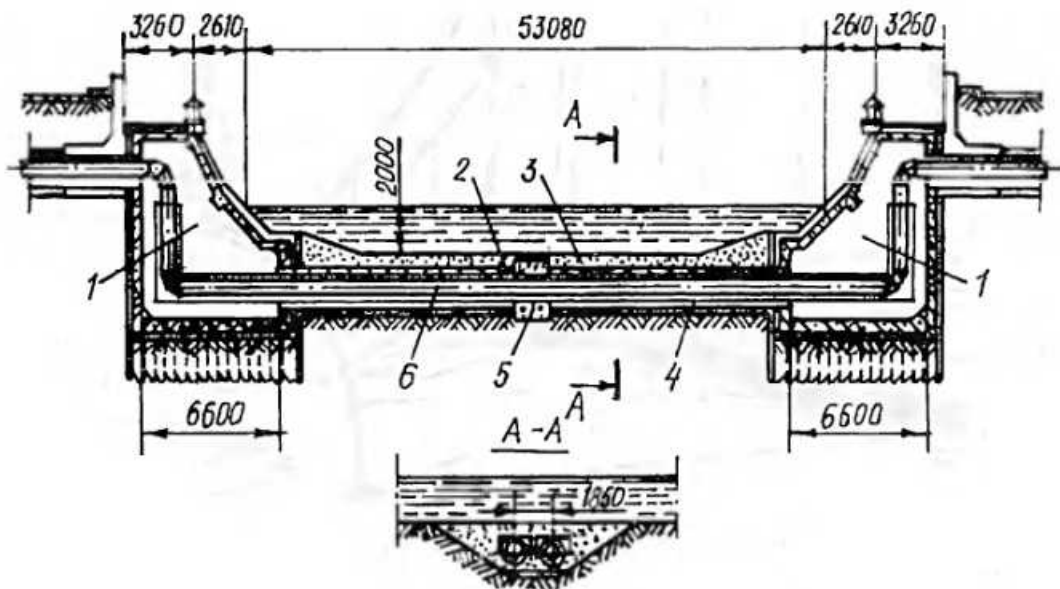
Підводний перехід теплопроводів у вигляді дюкера: 1 - берегова камера; 2 - залізобетонний вантаж; 3 - присипання гравієм і піском; 4 - футляр; 5- нерухома бетонна опора; 6 - теплопровід
